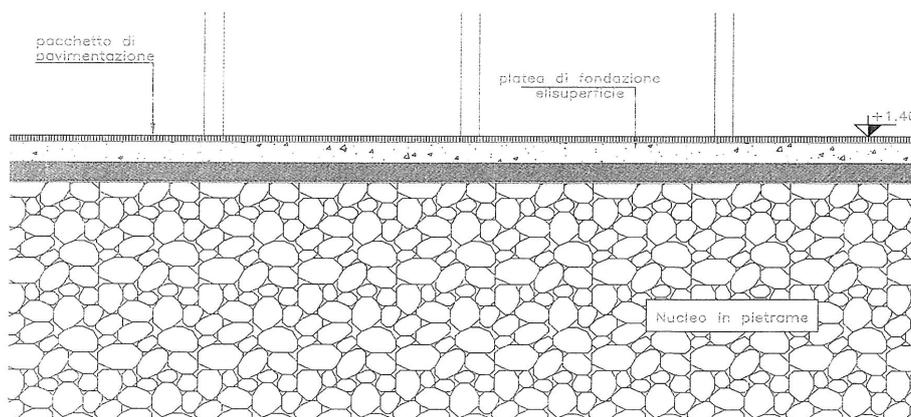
Sezione strutture esistenti: pacchetto di pavimentazione industriale, riempimento e platea e nucleo di fondazione
